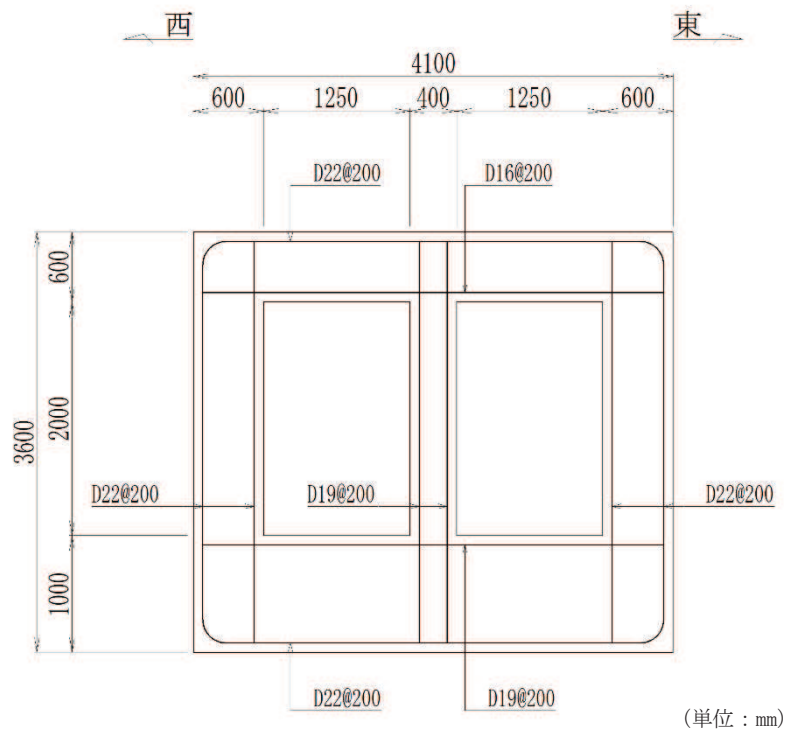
軽油タンク連絡ダクト概略配筋図 (A-A 断面)
